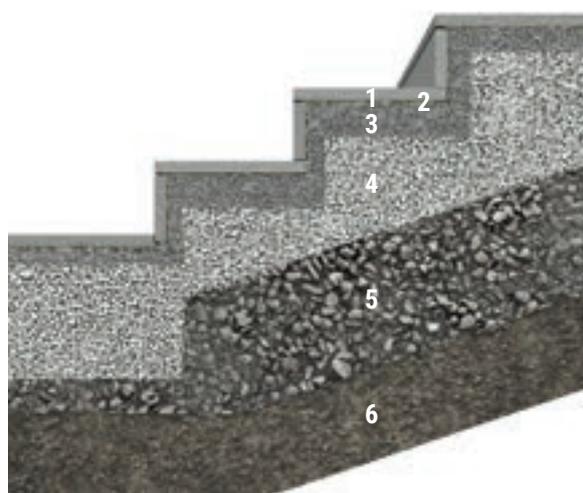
Stufenaufbau mit Blocksteinen im Drainbetonbett
